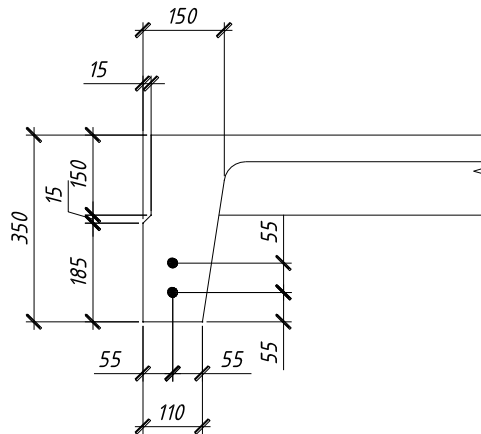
Поперечний переріз поздовжнього ребра.
